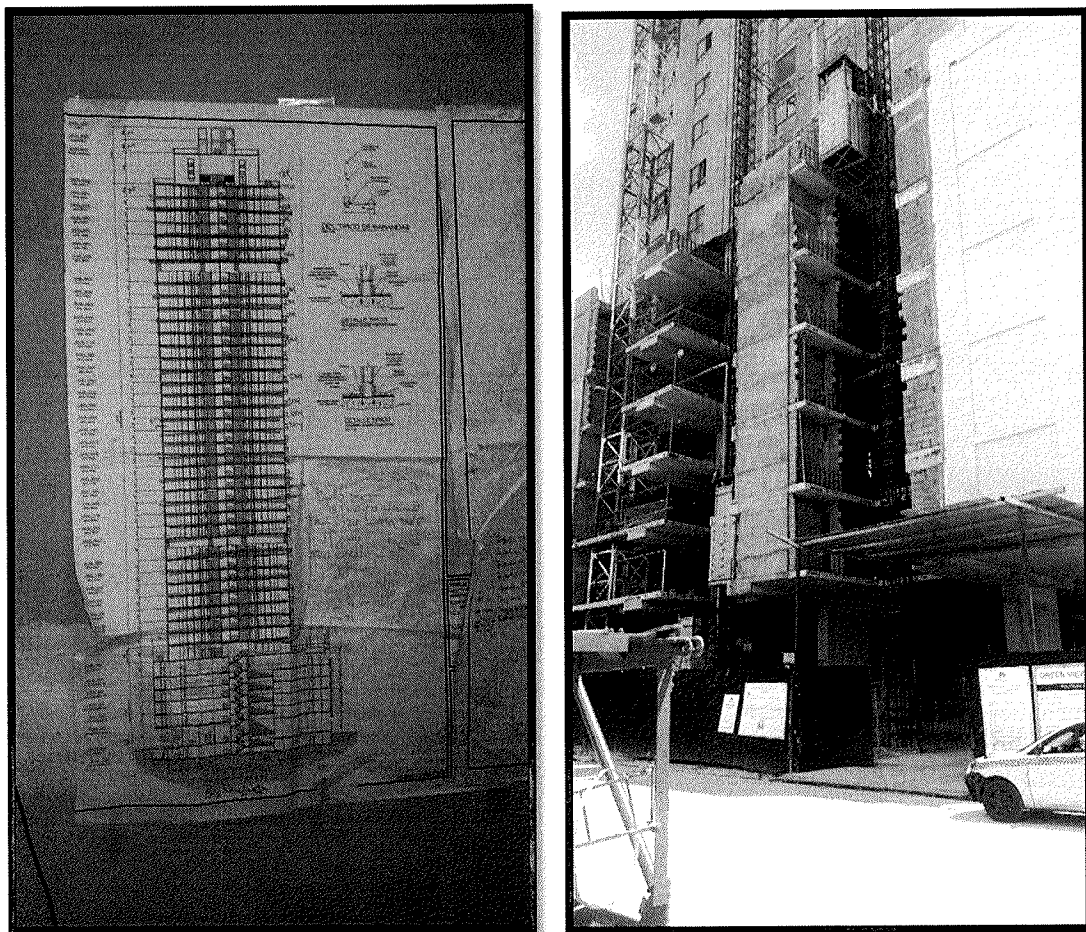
Se observa los planos de la edificación y en la foto de la derecha la parte frontal de la edificación.
